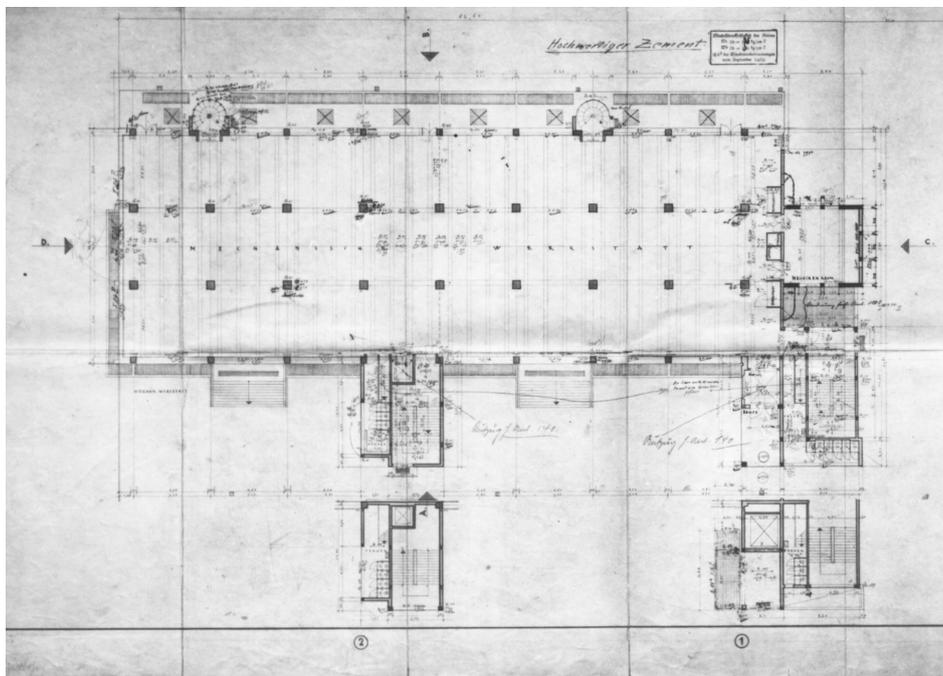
Grundriss Erdgeschoss, Haus A, 15. Juli 1929
